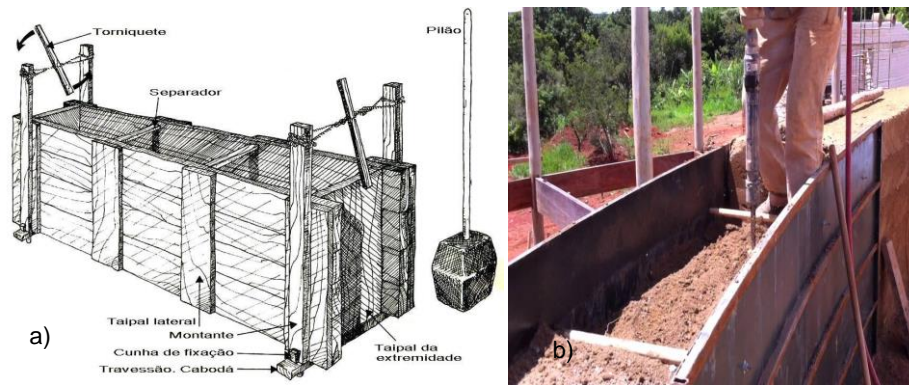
a) Taipal e pilão tradicionais (Eusébio, 2001). b) Construção em taipa moderna.
